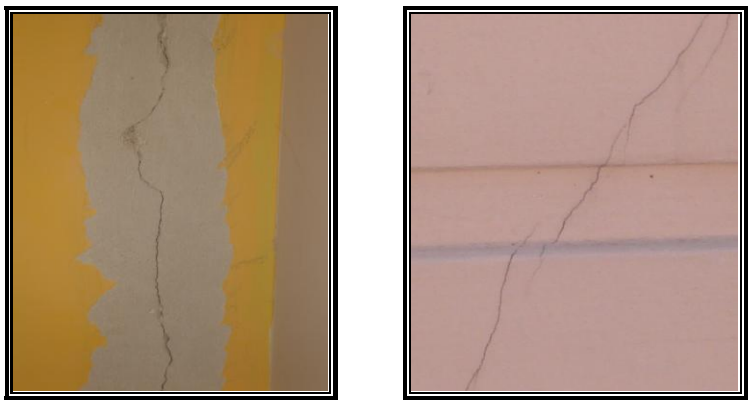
Fallas Ocasionadas por la Falta de Juntas de Contracción, en donde el Concreto se ha Agrietado Aleatoriamente.
